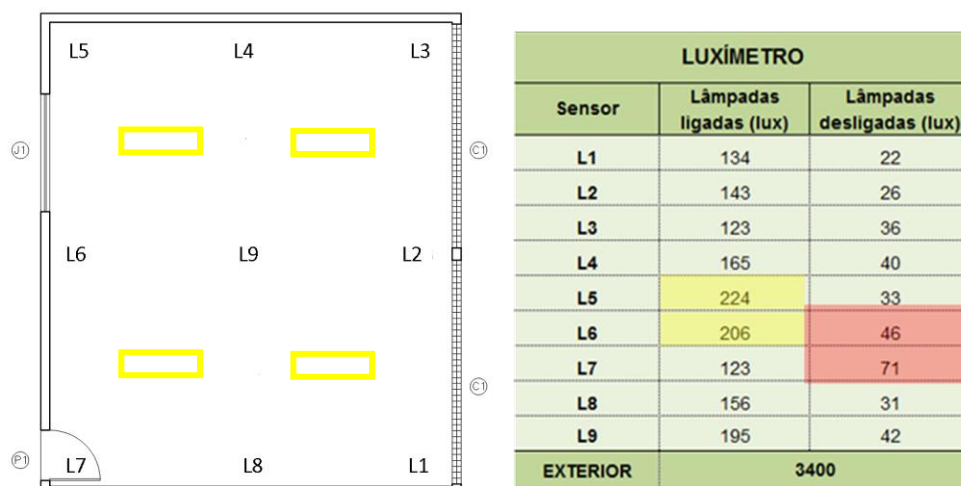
Planta baixa da sala com pontos de medição e localização das lâmpadas fluorescentes existentes.
